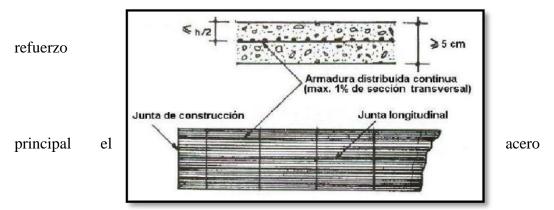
Pavimento con refuerzo continuo longitudinal siendo este colocado longitudinalmente a lo largo del pavimento. Cuyo
